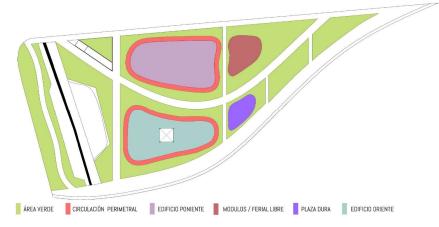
Esquemas de zonificación final espacio exteriores. Fuente: Elaboración Propia.
